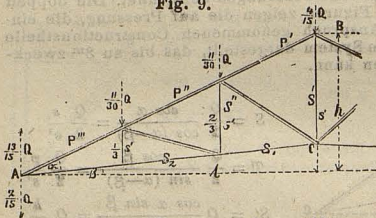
stellt eine bis 20^m brauchbare Construction dar.
